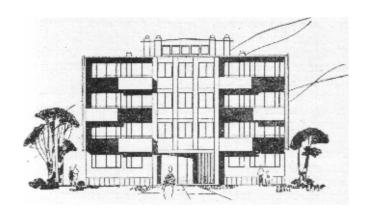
Односекционный пятиэтажный дом (Франция) На этаже пять квартир, лестница освещается верхним фонарем
